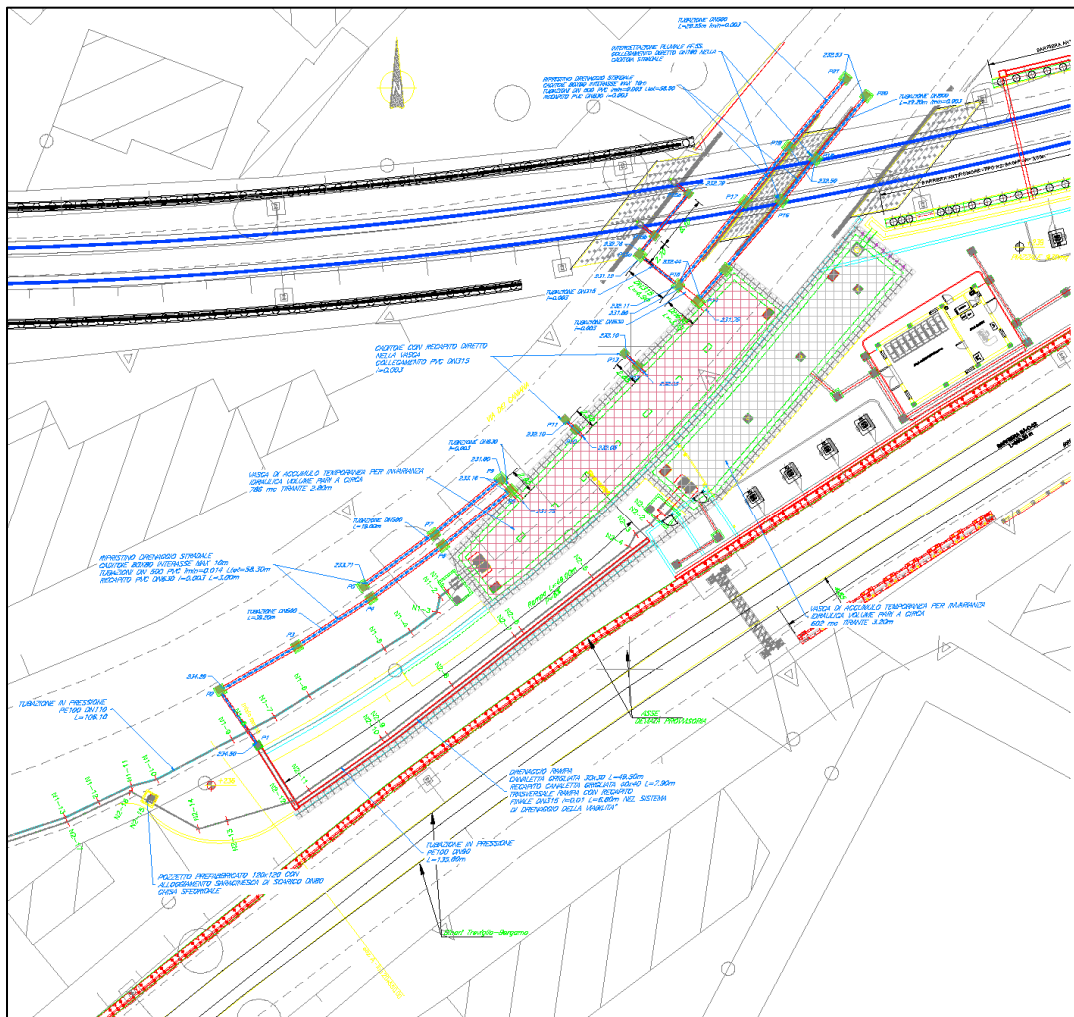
Stralcio planimetrico sistema di drenaggio.
